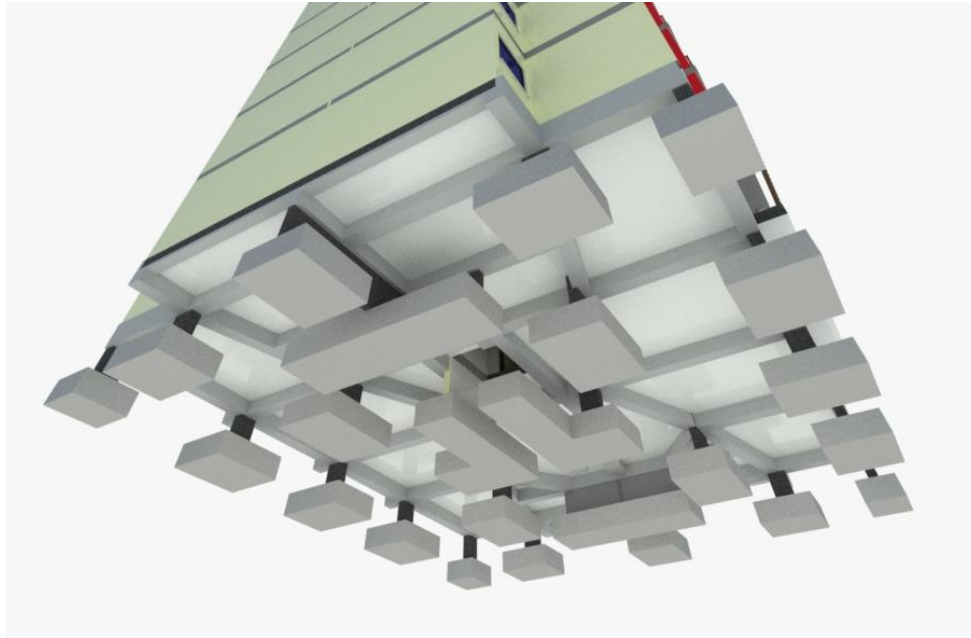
Vista en Planta Proyecto Altos de Araguañey
